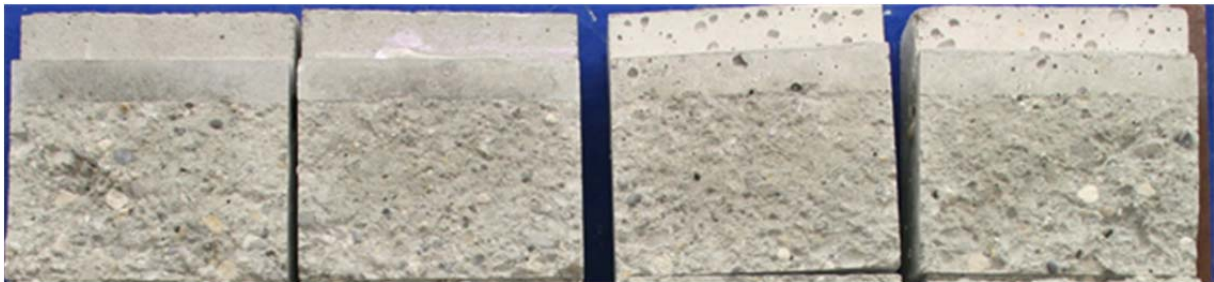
Bruchbild Betontage „frisch in frisch“, Rüttler vertikal
